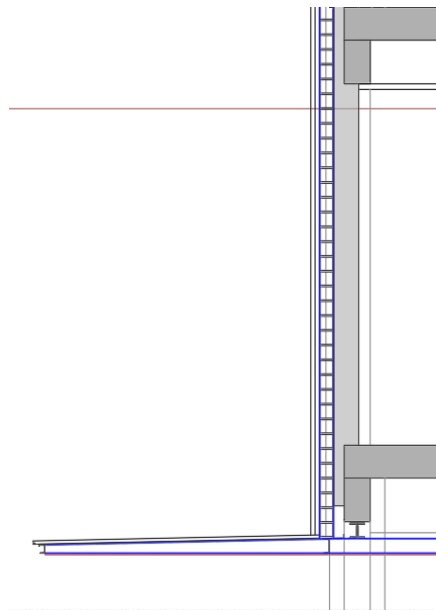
Detalle de fachada Sur, planta segunda. Autor: Estudio VVV
